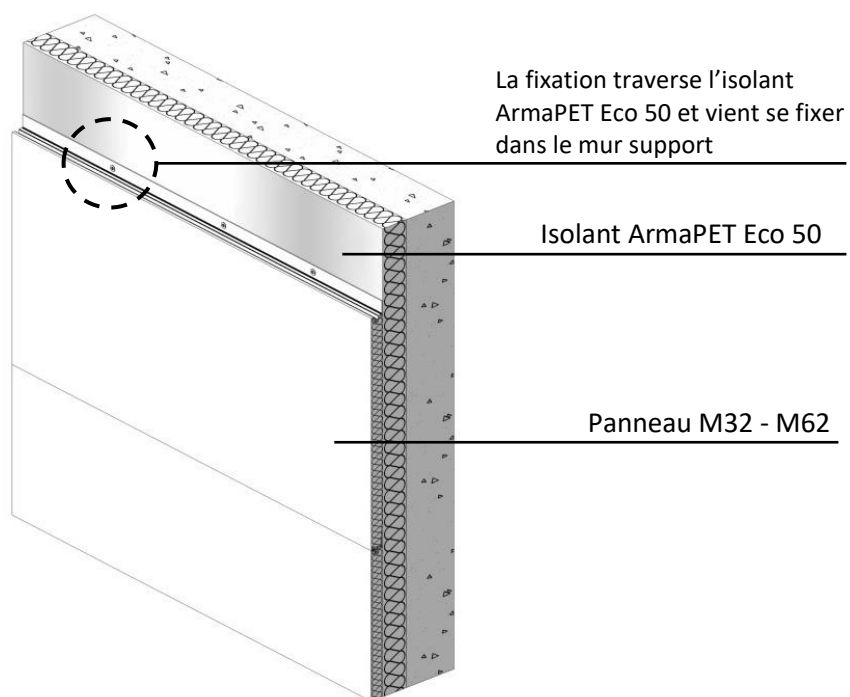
Pose sur mur béton ou maçonné (lames horizontales)
